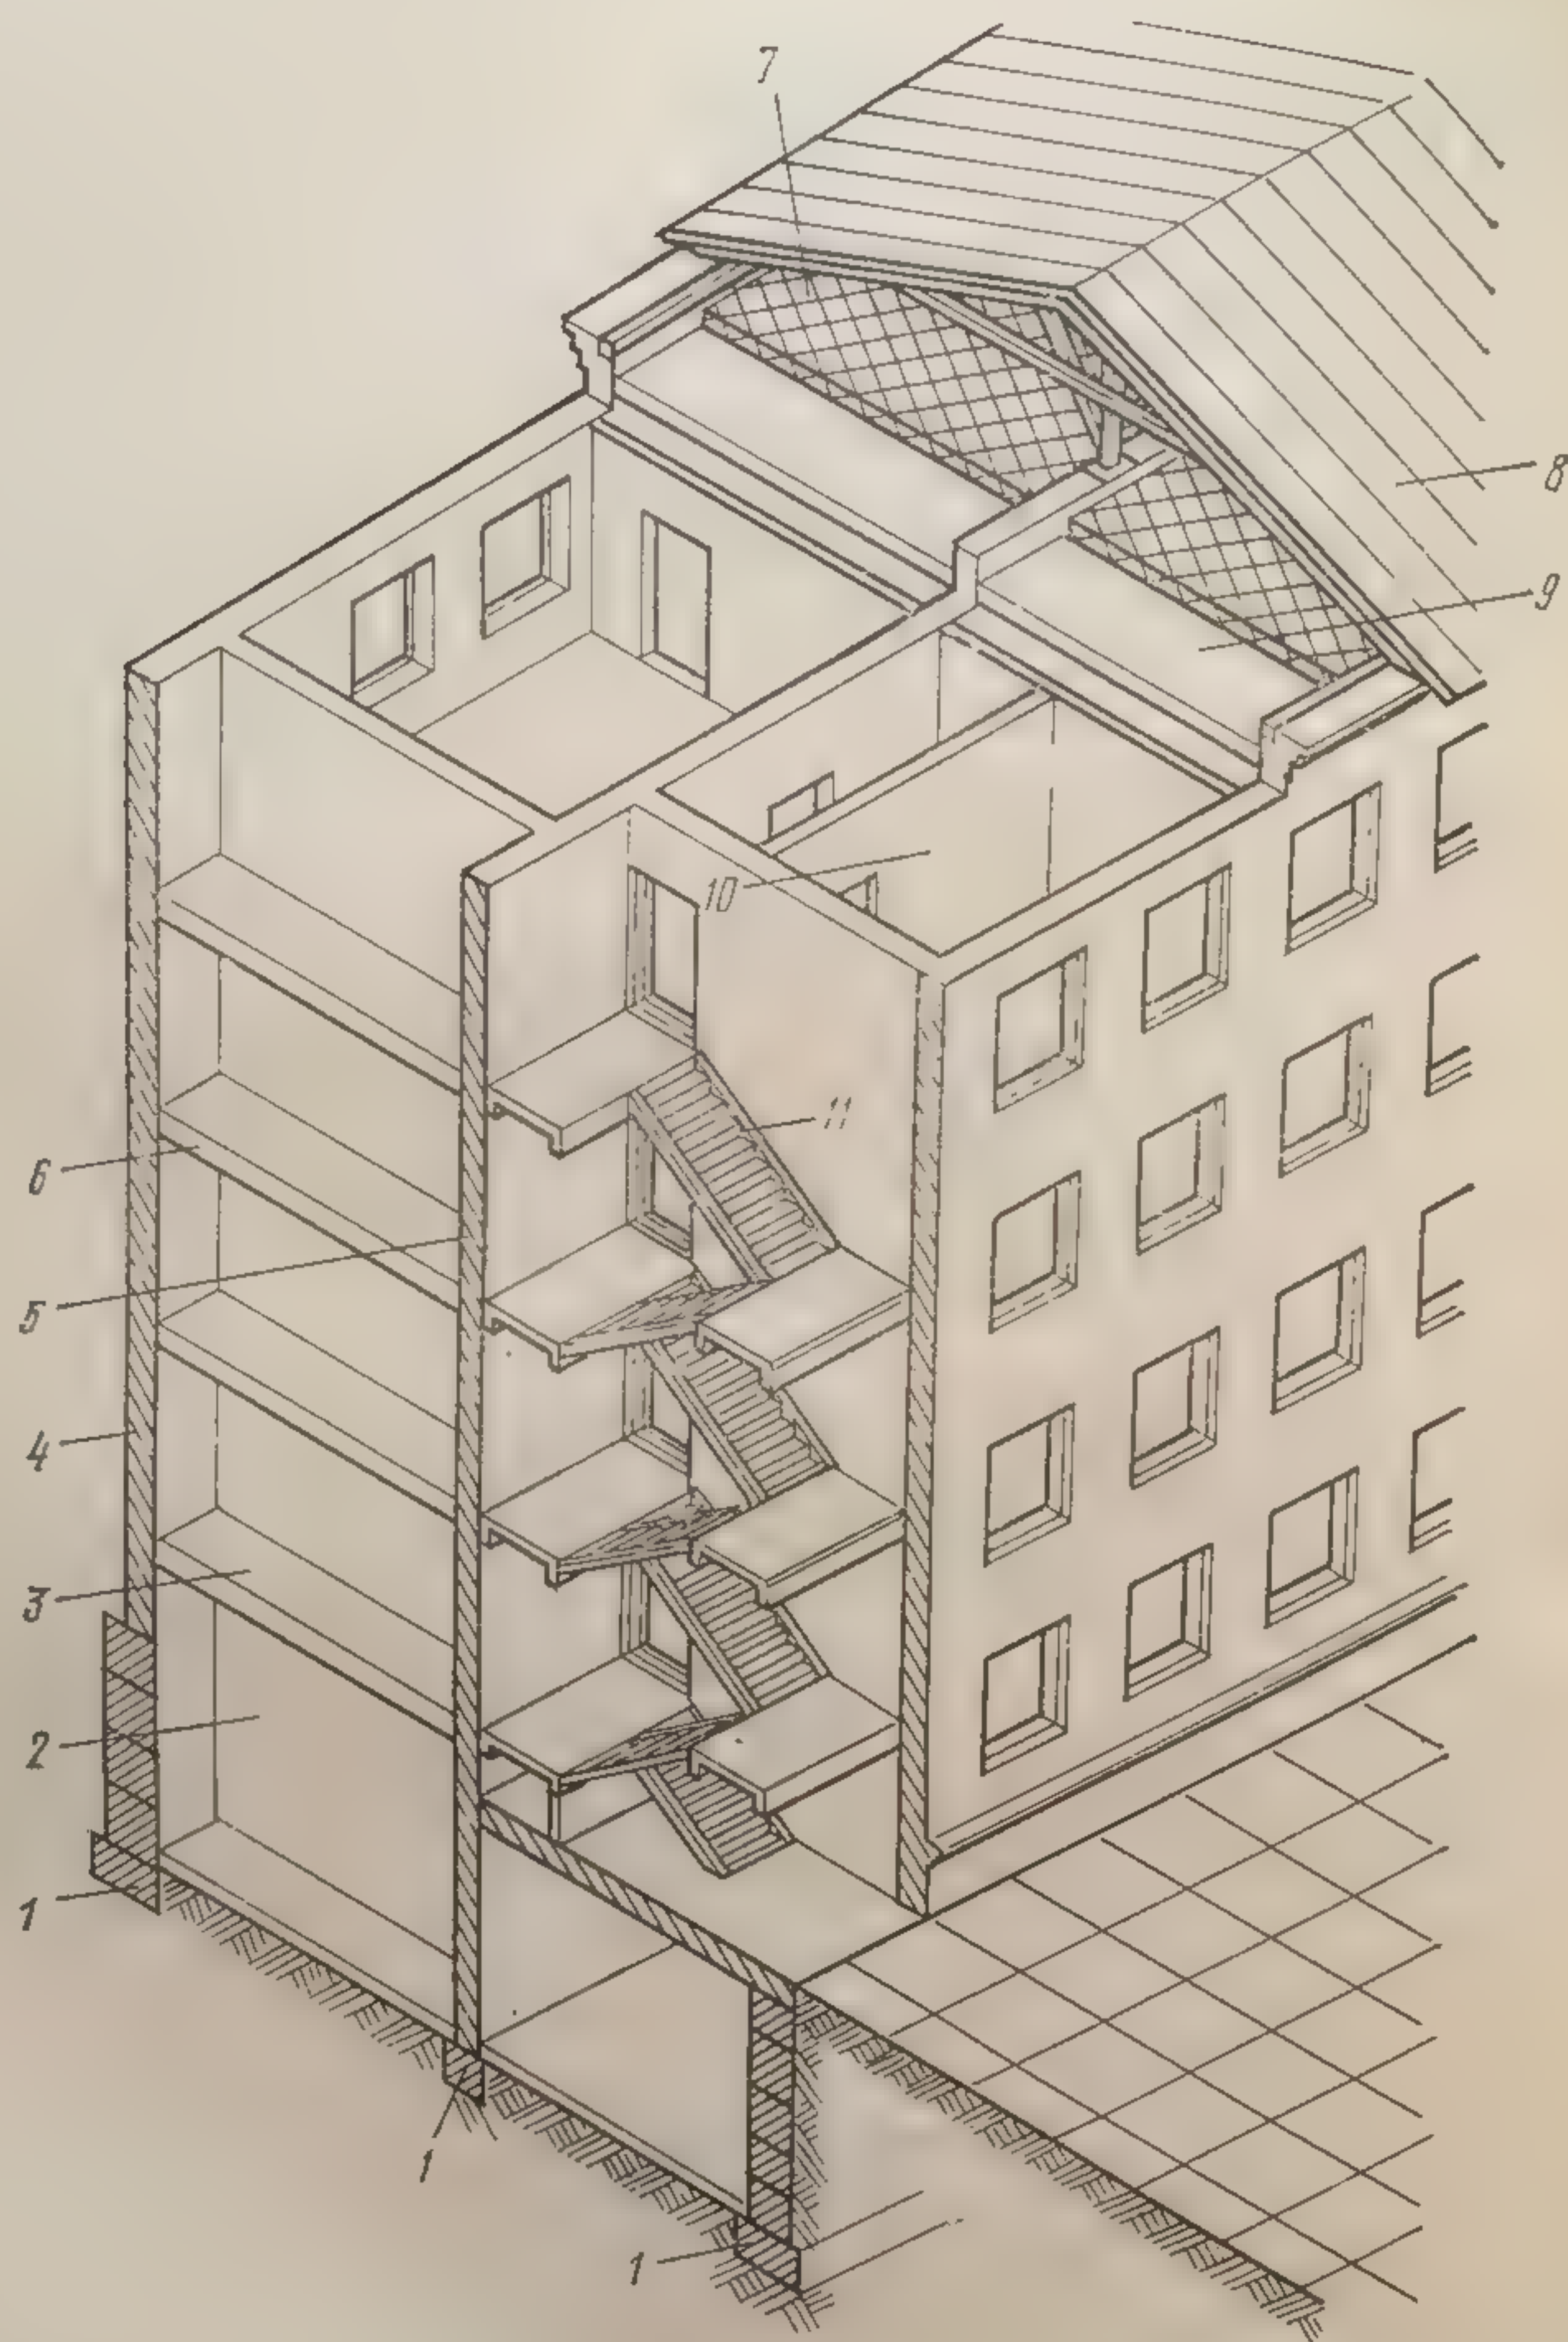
Конструкции многоэтажного жилого дома с кирпичными стенами:
